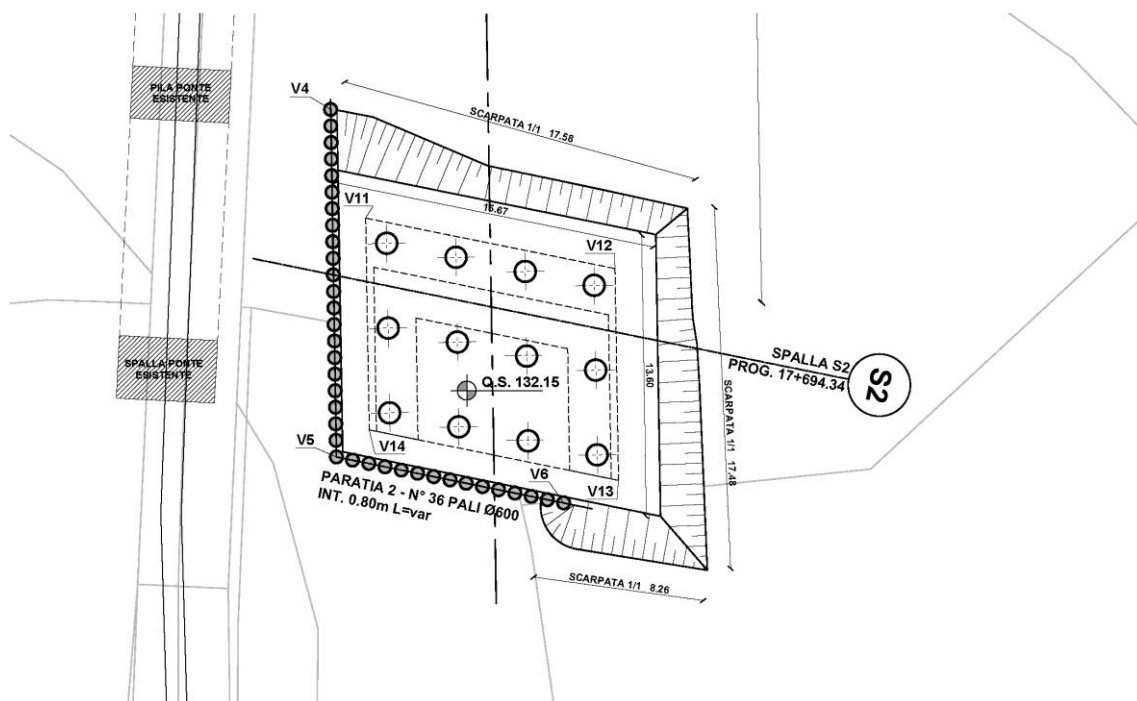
Pianta ubicazione paratie: pali C.F.A. 600mm, spalla S2.
